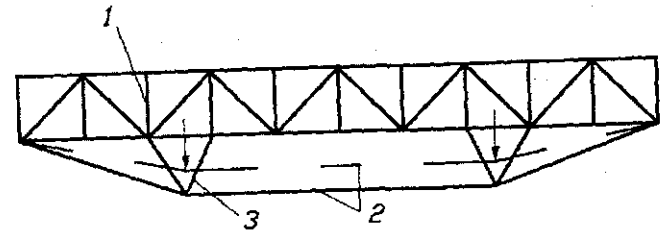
Предварительное напряжение пространственной стержневой конструкции с пирамидальными стойками шпренгеля за счет оттяжки вниз к вершинам пирамид затяжки: 1 — пространственная конструкция; 2 — затяжка; 3 — пирамидальная стойка шпренгеля
